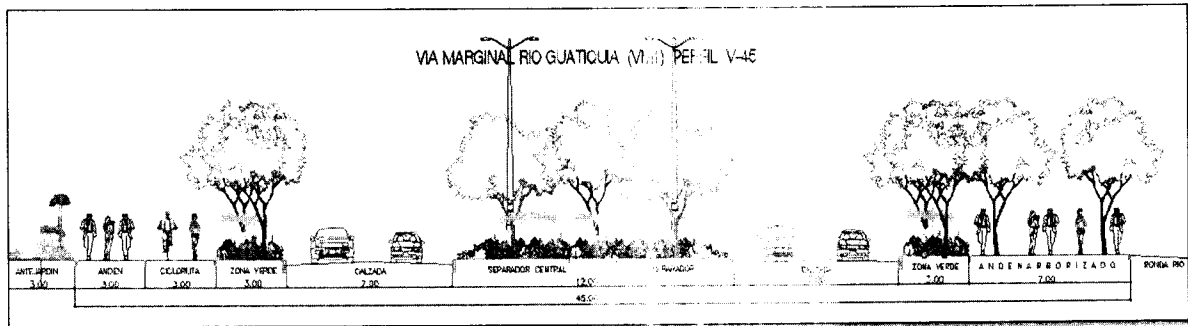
Distribución en planta: Perfil: Vía VM1 (45MTS)
